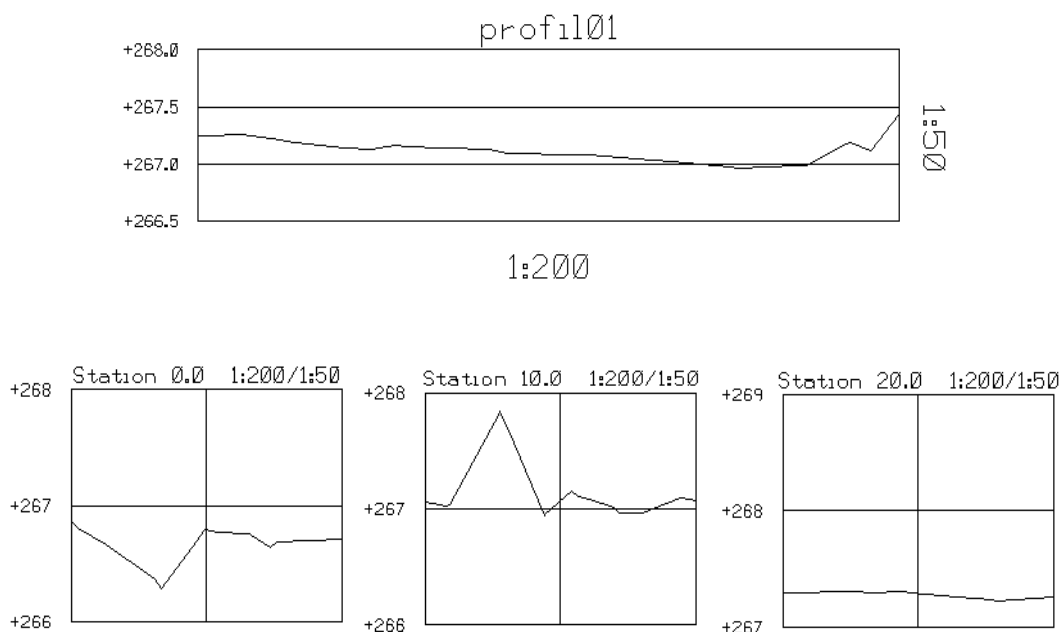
Профіль подłużний і przekroje poprzeczne („DRAW PROFILE”, „DRAW ALIGNMENT SECTIONS”)
